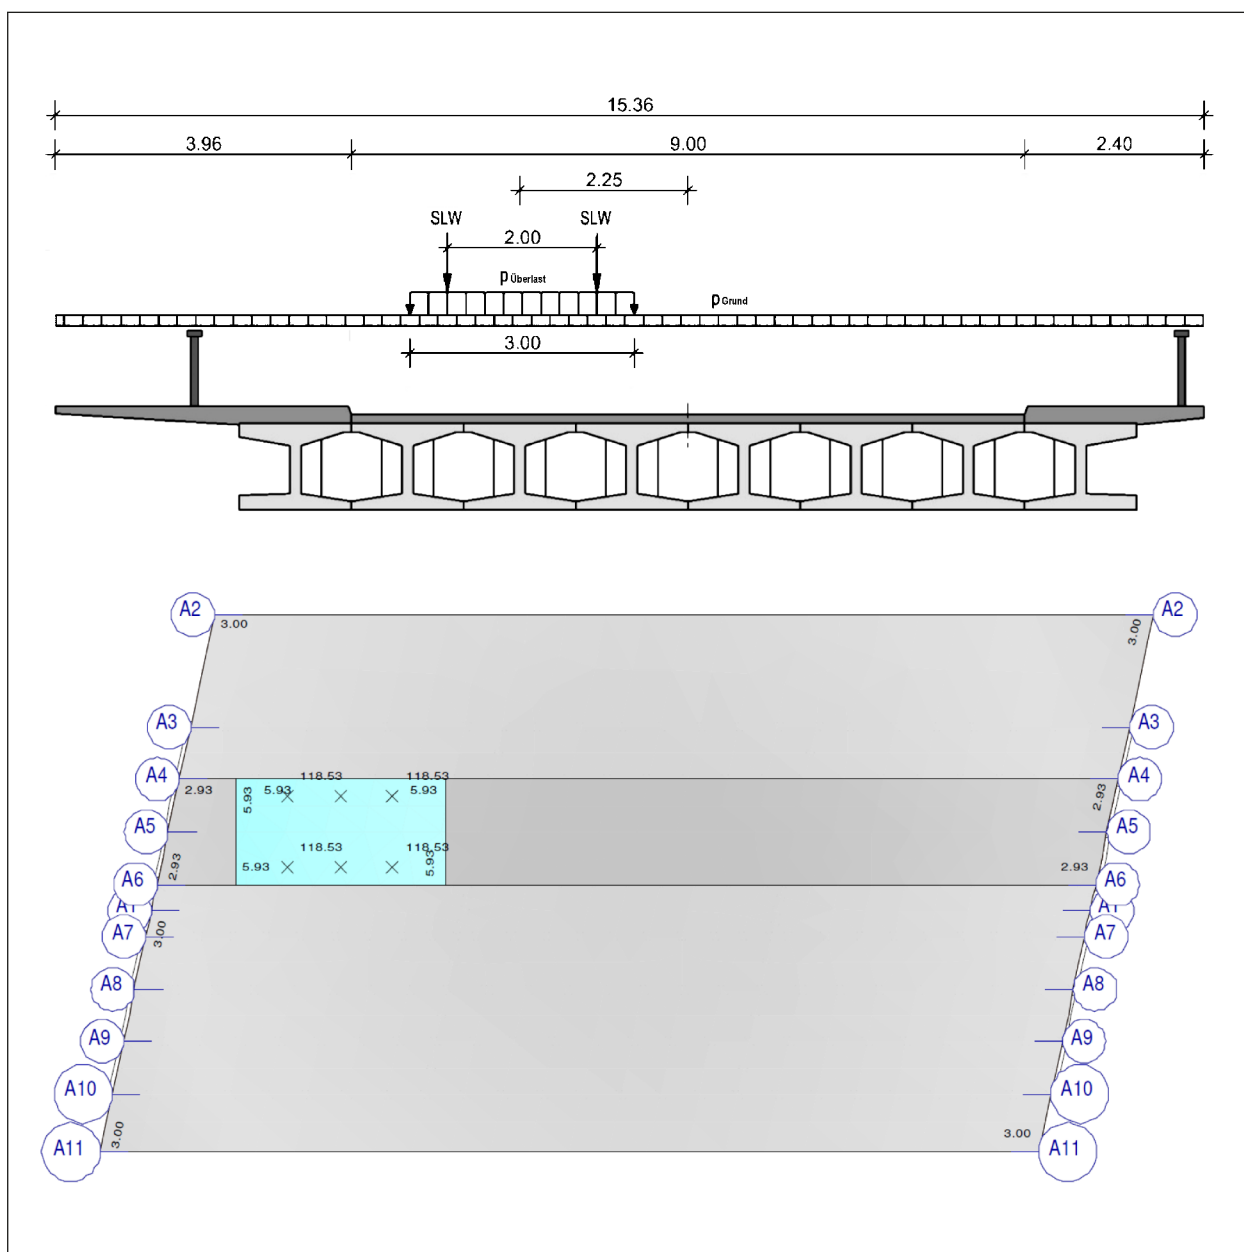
Verkehr BK60 – Laststellung 2: Schnitt und Draufsicht
